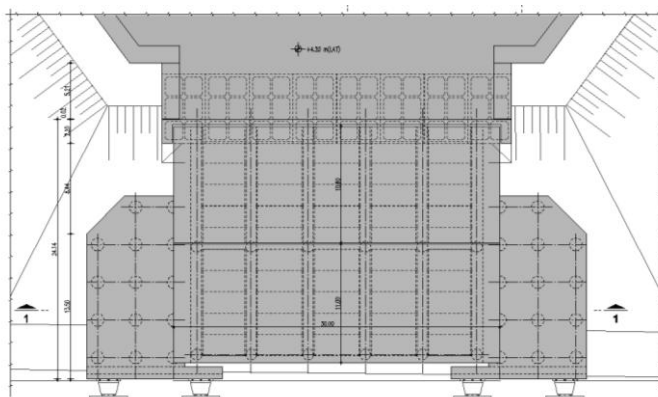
Planta da plataforma central e dos duques d`alva de acostagem.
